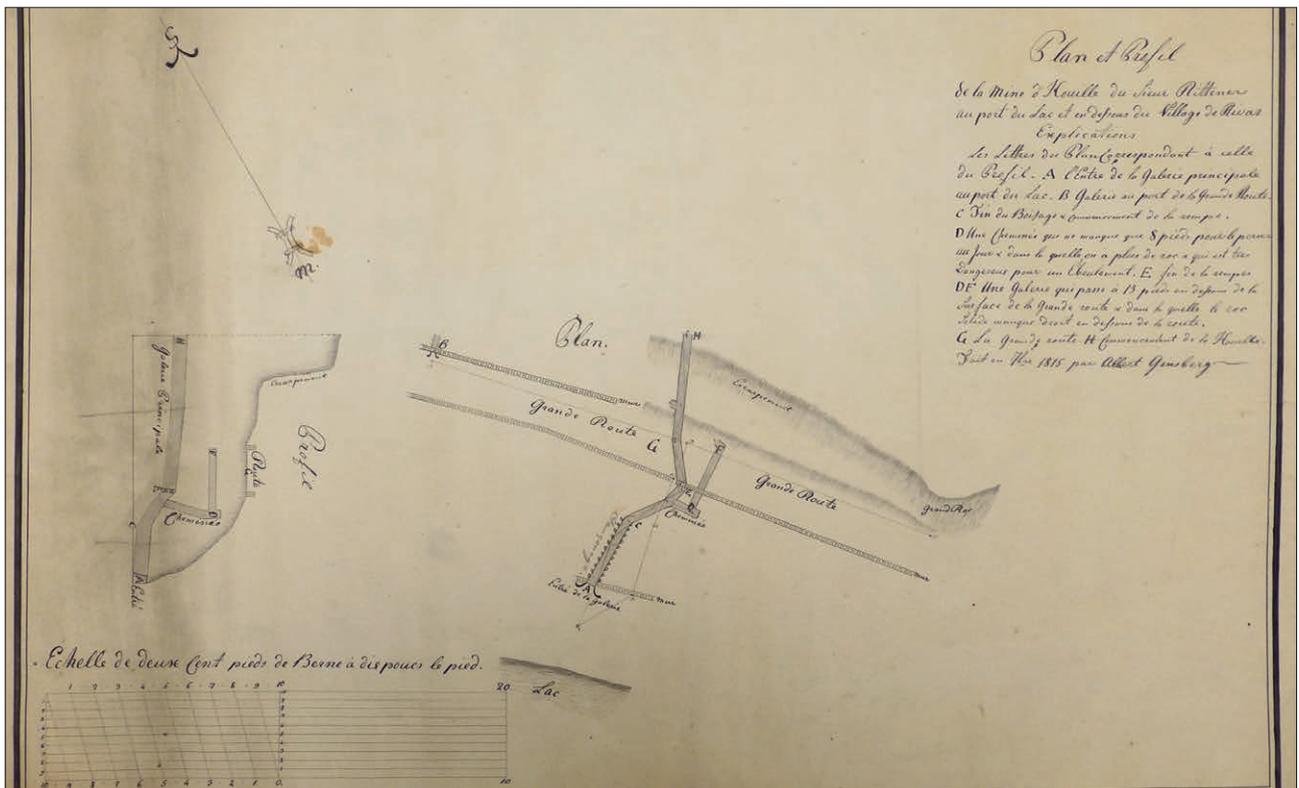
Plan et profil de la mine de houille de Rivaz en 1815 par Albert Ginsberg. Cette mine inaccessible de nos jours se situait sous la route cantonale, entre l'entrée occidentale du village de Rivaz et l'actuel Lavaux-Vinorama. Elle fut exploitée par « le Sieur Rittener » entre 1809 et 1816. Deux petits enfants étaient chargés de transporter à l'extérieur le charbon abattu par un mineur. Archives cantonales vaudoises (ACV GC 150 A Rivaz).
